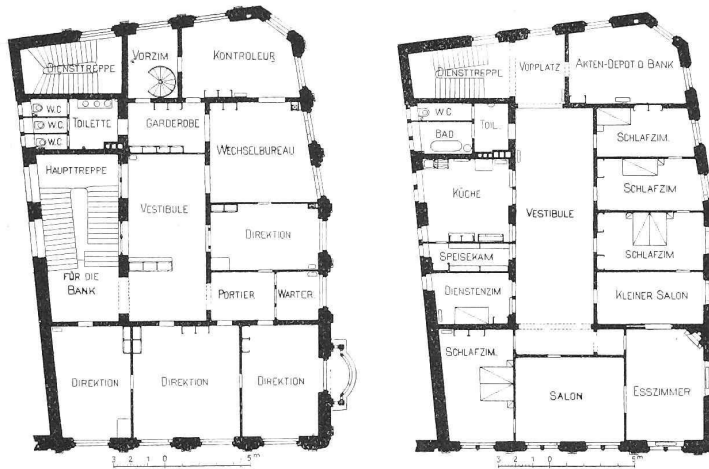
Grundriss vom I. Obergeschoss. — 1:400. — Abb. 5. Grundriss vom III. Obergeschoss.
